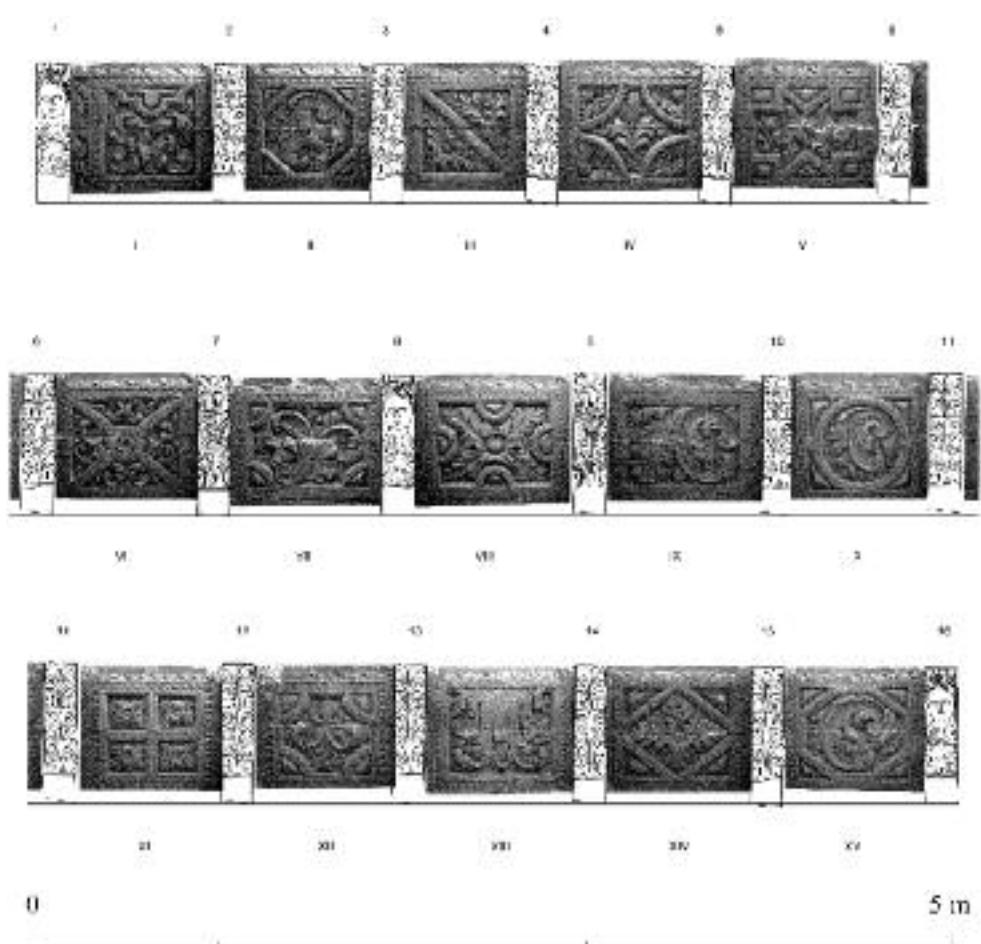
Planta, vista desde abajo, del alero de la casa de los Monterde.
